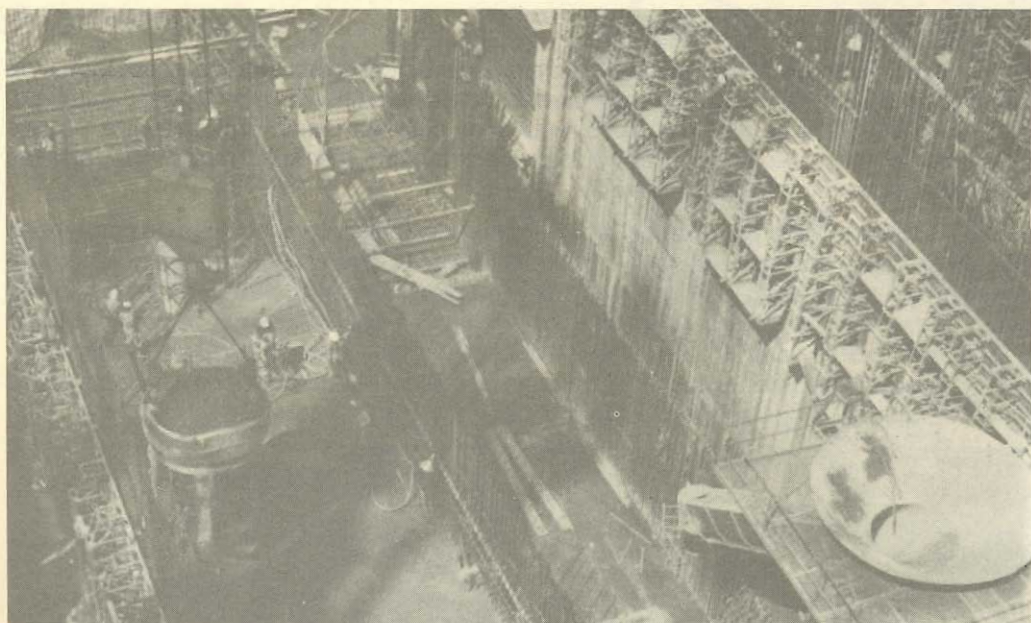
Calha inclinada para lançamento de concreto - Tucuruí
